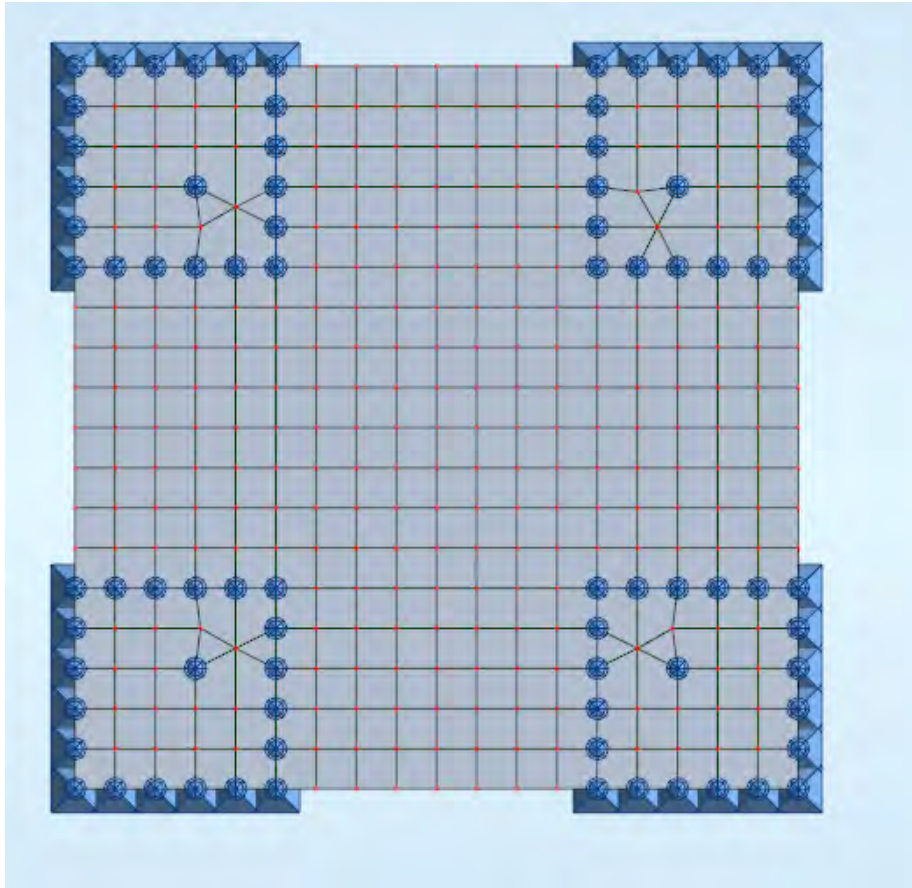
Modelo de un paño con bordes restringidos -vista planta. (R1PBR)
